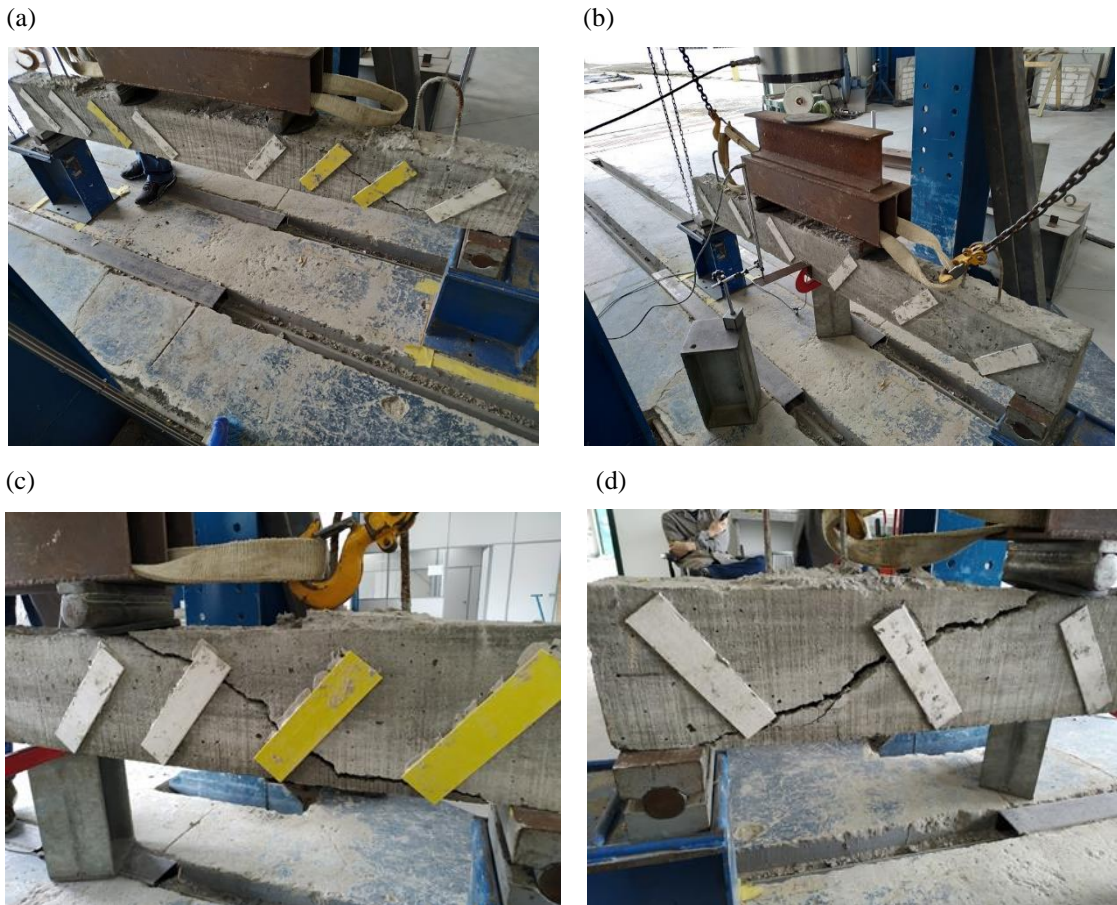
Ruptura das vigas com reforços: (a) Viga do grupo 100 sob carregamento, (b) Viga do grupo 175 sob carregamento, (c) Viga do grupo 100 após o ensaio, (d) Viga do grupo 175 após o ensaio.
